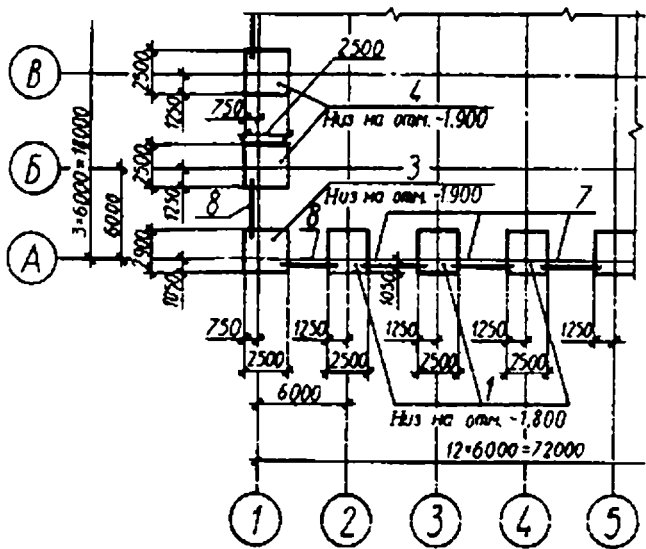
Пример схемы расположения фундаментов и фундаментных блоков
